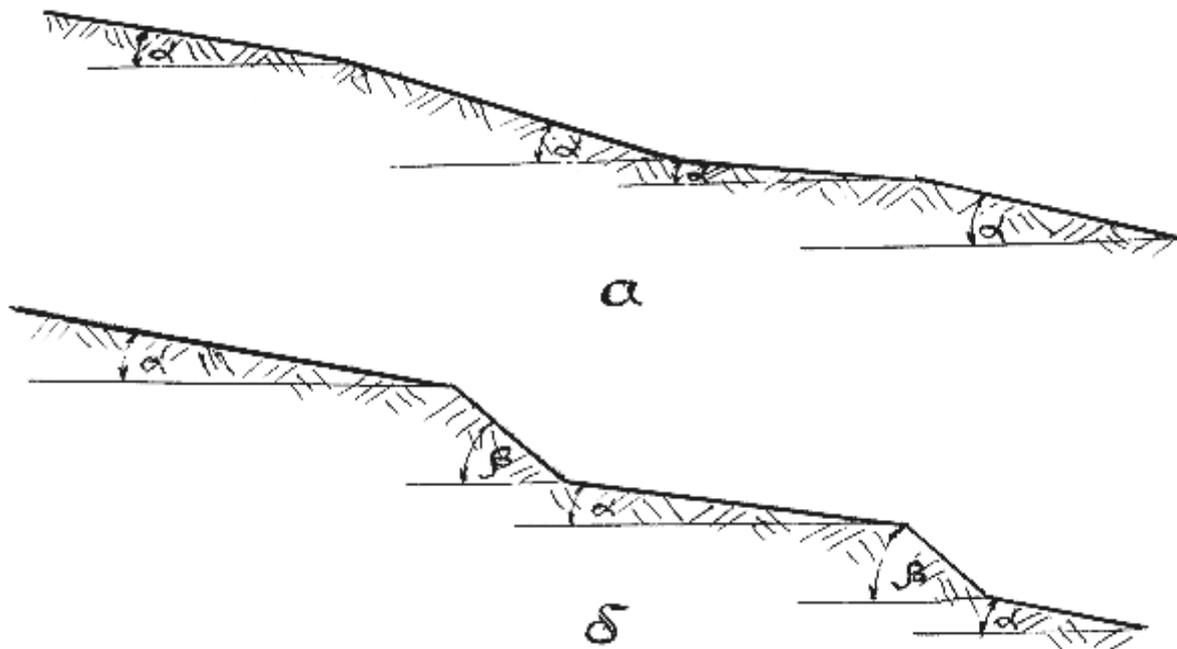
Схемы вертикальной планировки площадки объекта : а – бестеррасная; б – террасная ; α – углы уклонов планировочных плоскостей ; β – углы откосов между планировочными плоскостями.
